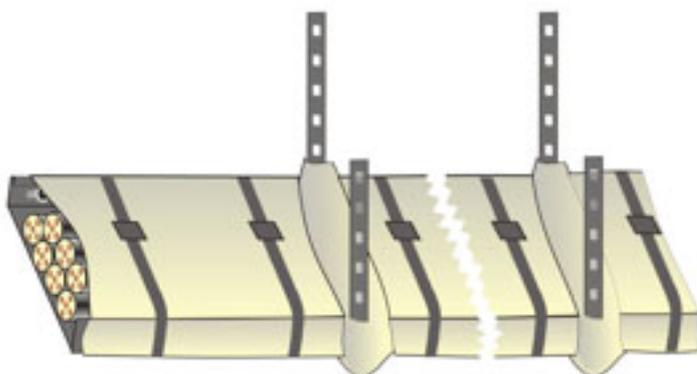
An einer Kabeltrasse montierte Kabelvollbandage (Werkbild BC-Brandchemie)
